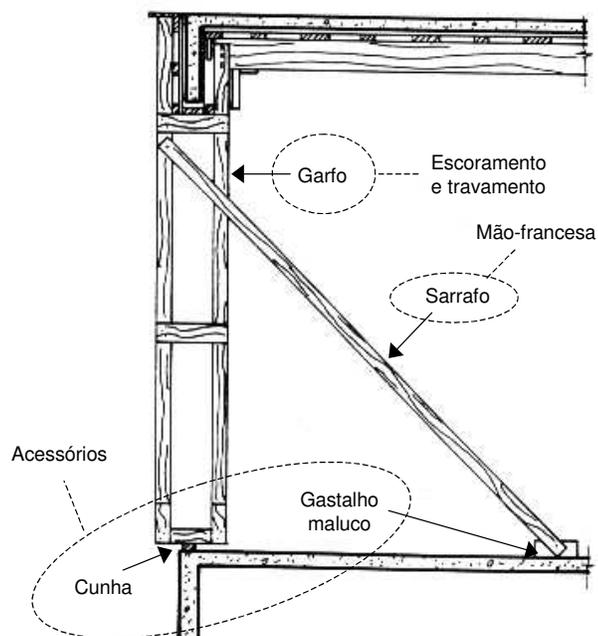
Corte de fôrma de viga de borda com escoramento/travamento com garfo de madeira e mão-francesa em sarrafo (CRISTIANI, 1995).
